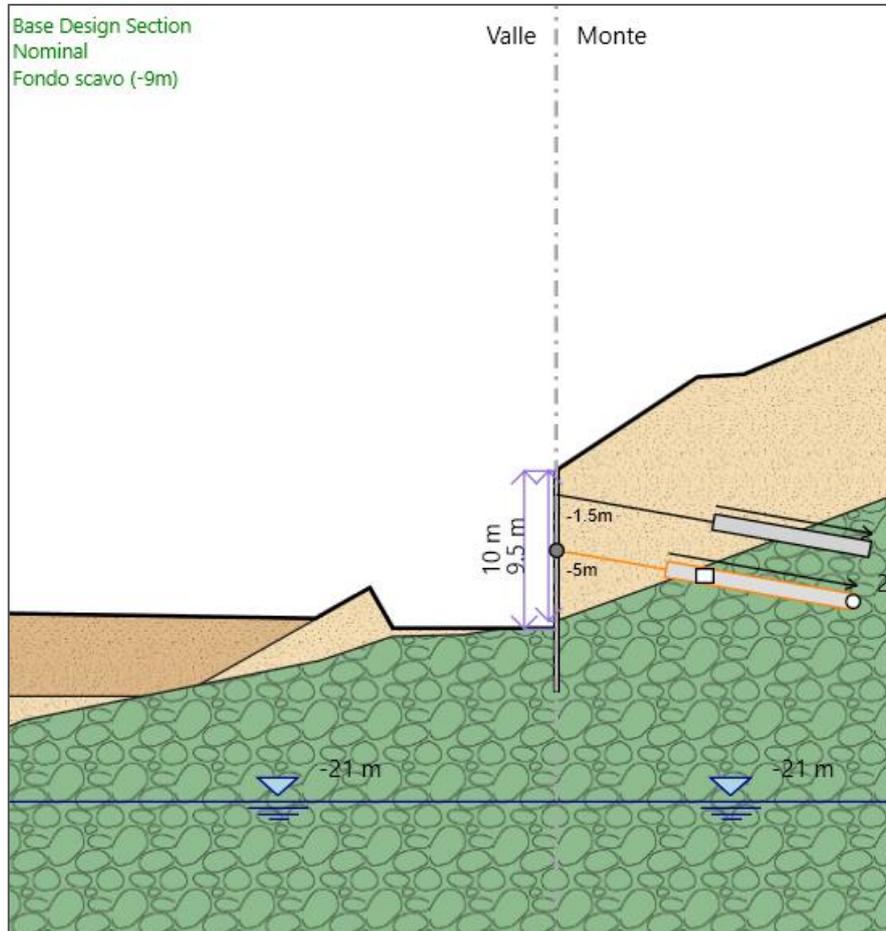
Sezione di progetto di Paratie – Altezza coltre 7,5 m
